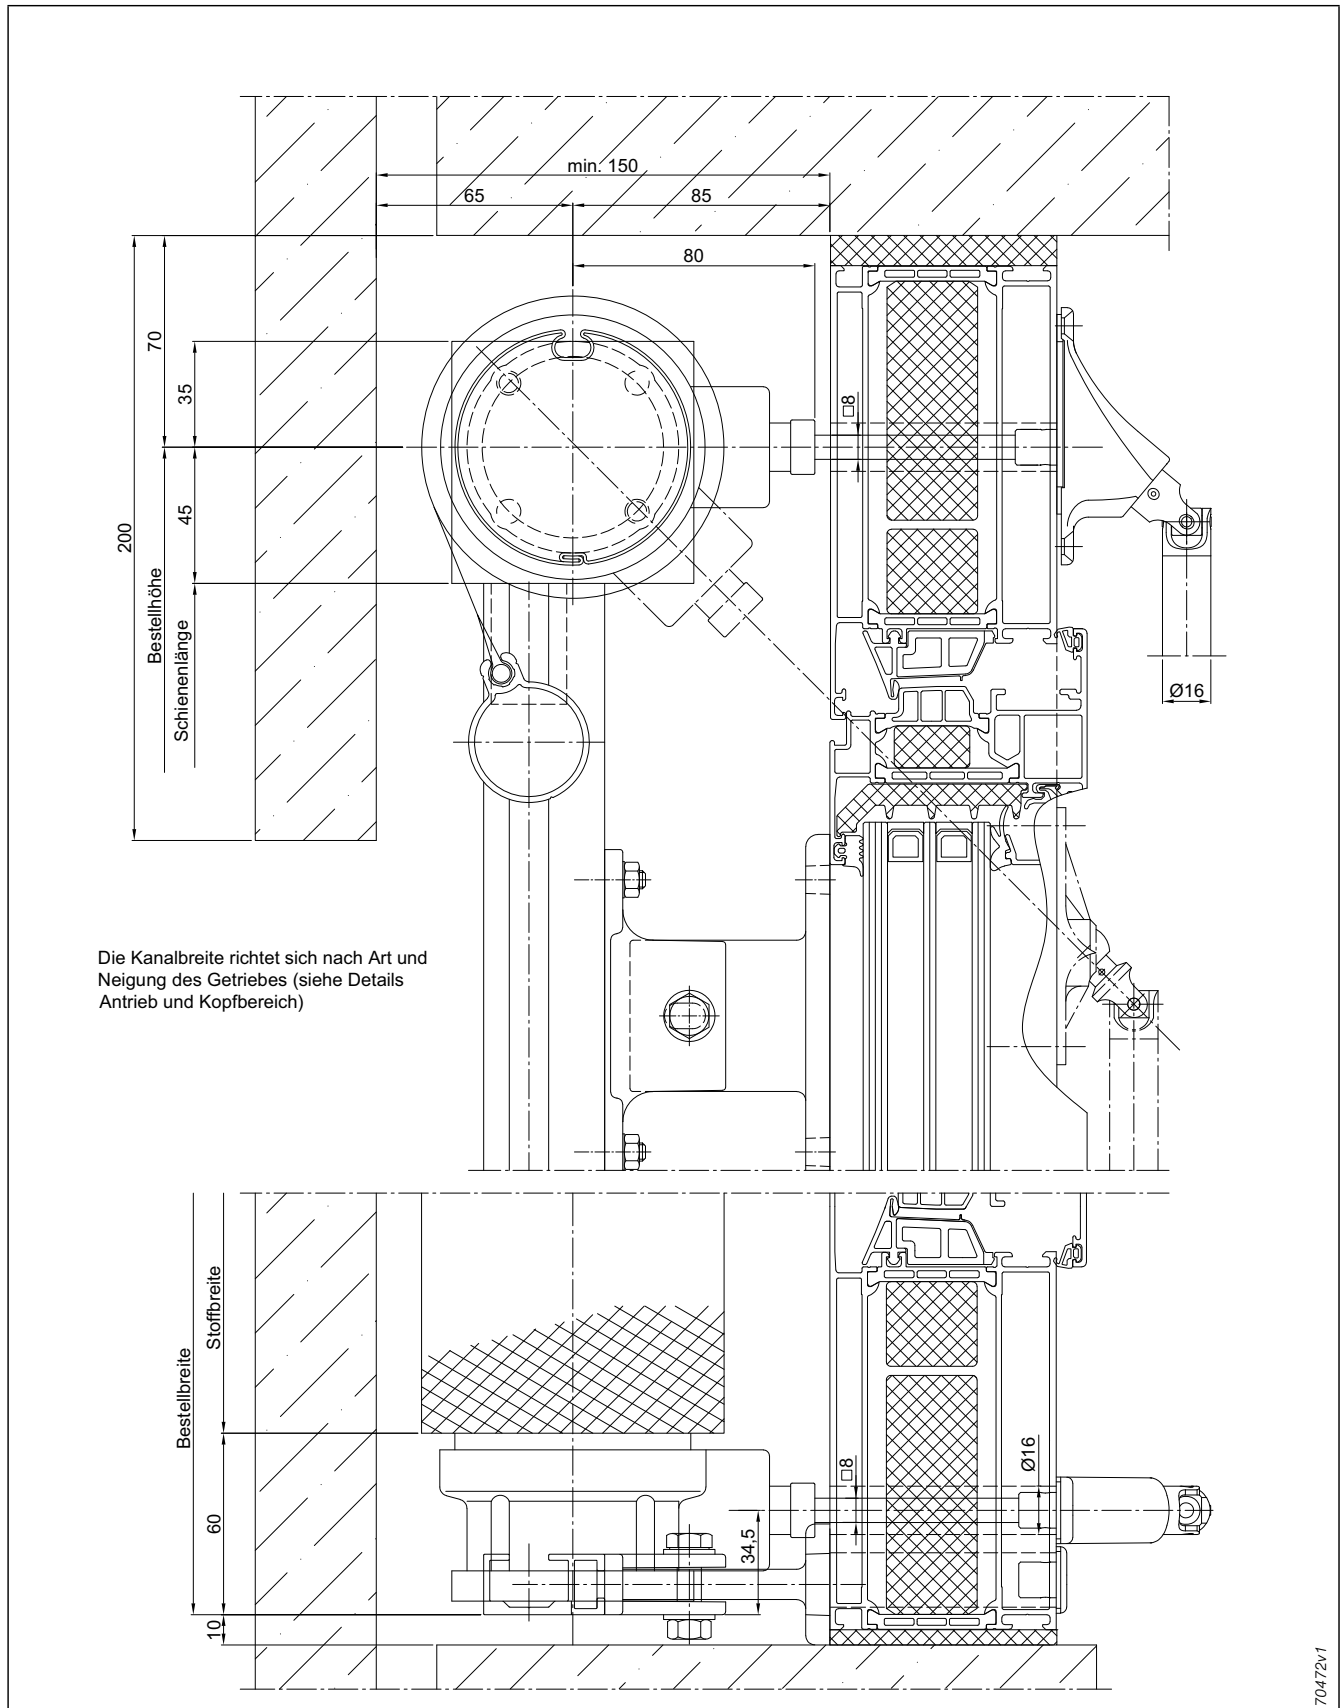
Fassaden-Markise 201, Getriebe 3:1 (Einzelanlage) Führungsschiene mit C-Nut 20x40 mm oder 38x40 mm in bauseitigem Kanal
